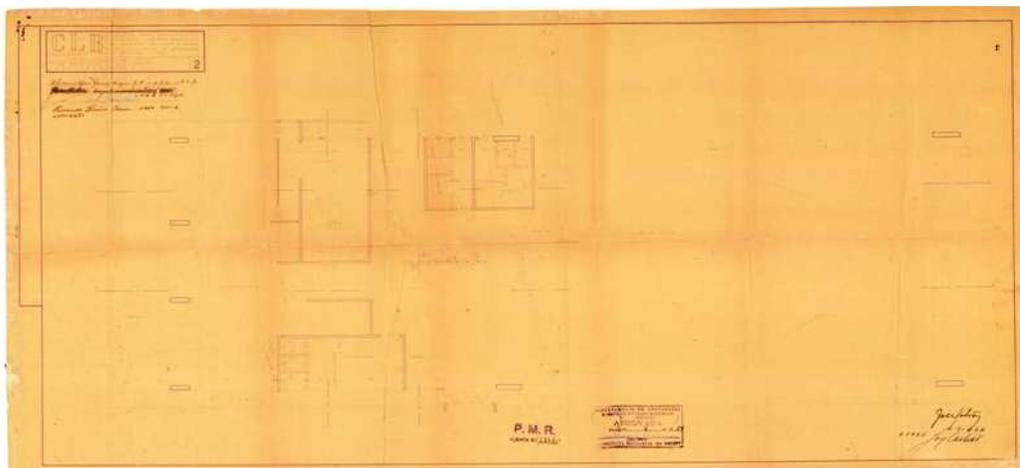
Planta Baixa Clube Líbano Brasileiro, projeto registrado na DIRCON, 1954.
